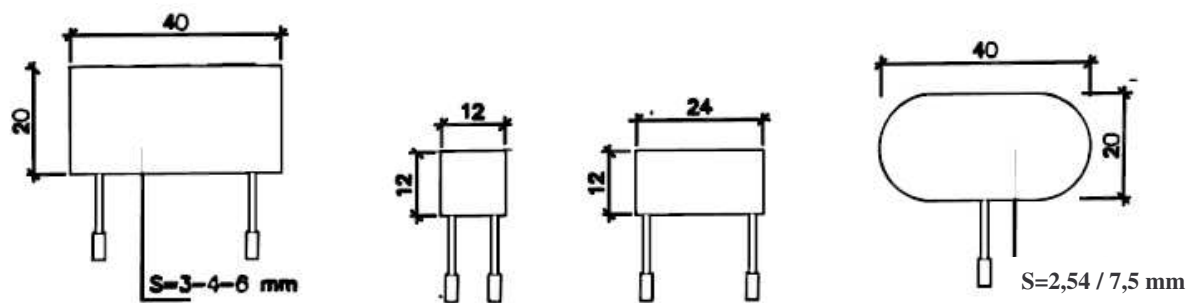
b - Forme e dimensioni di martinetti piatti per murature in laterizio
